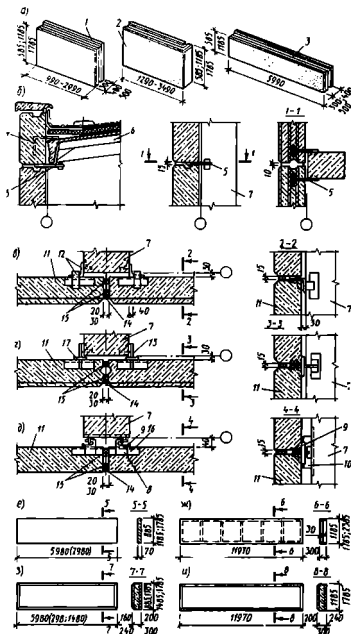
Стеновые ограждения блочные и панельные:
